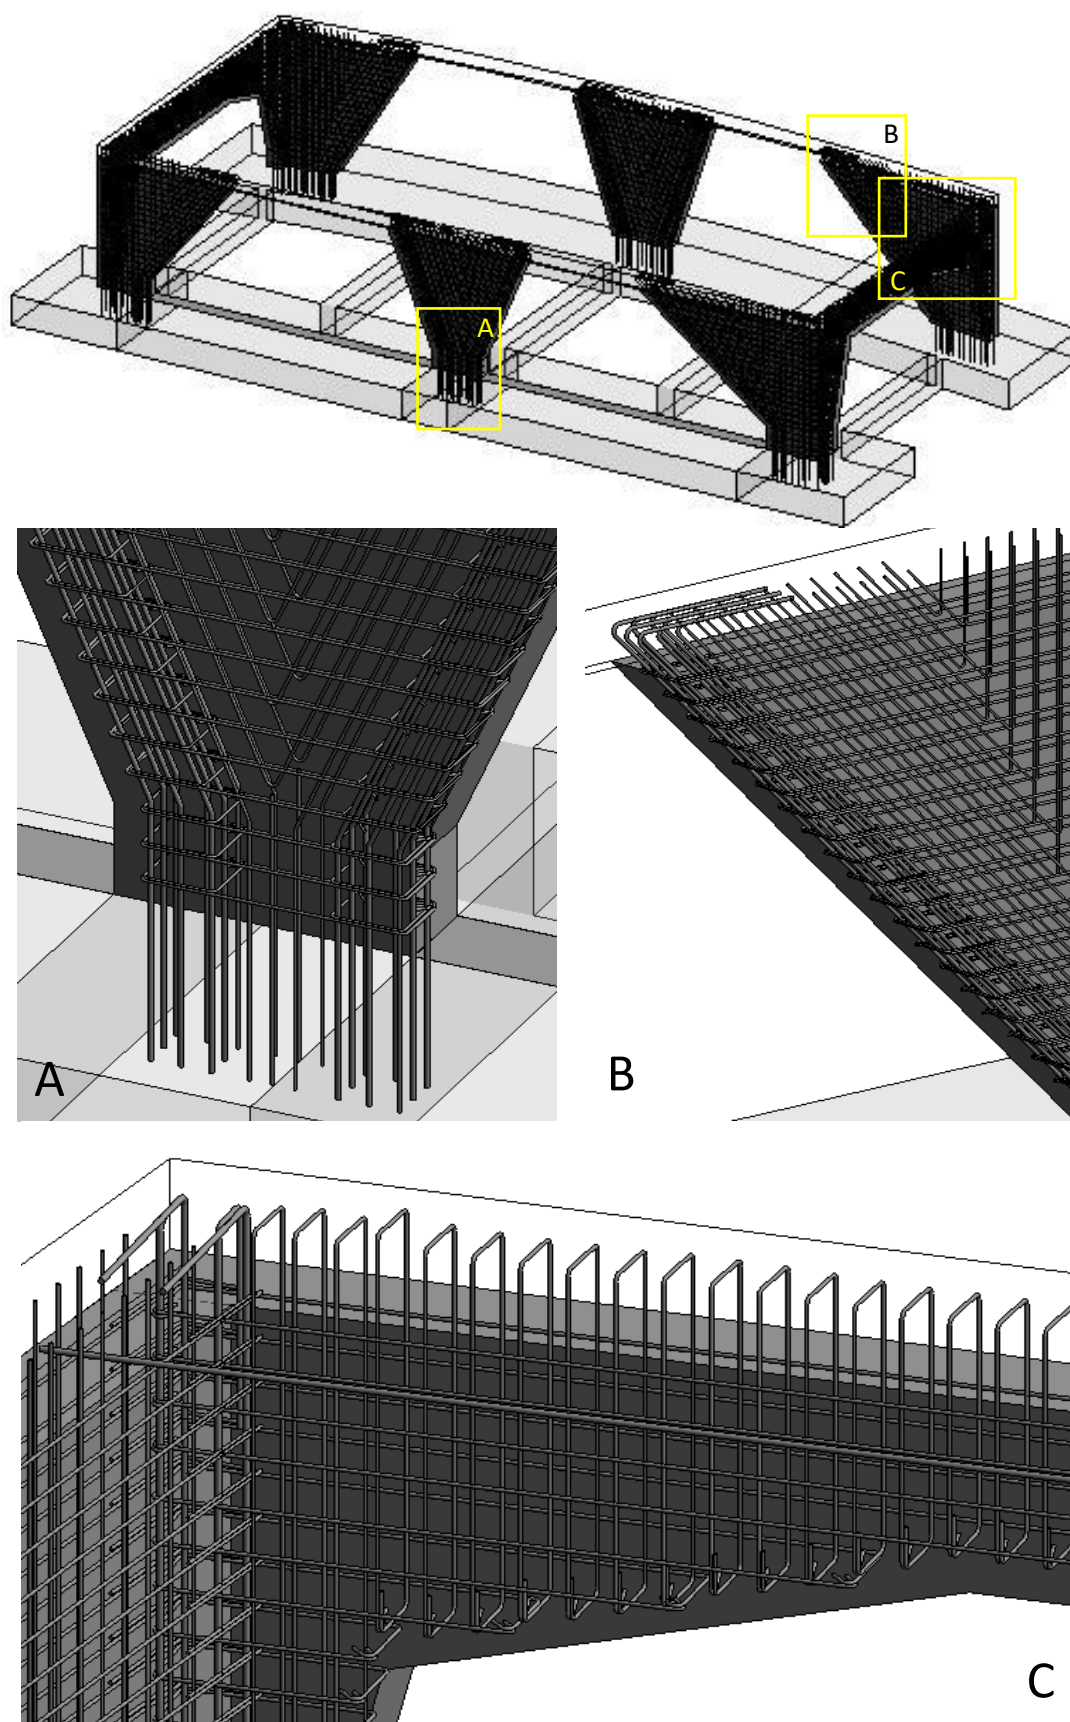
Modelos 3D de armaduras – Paredes suporte do centro de conferências
